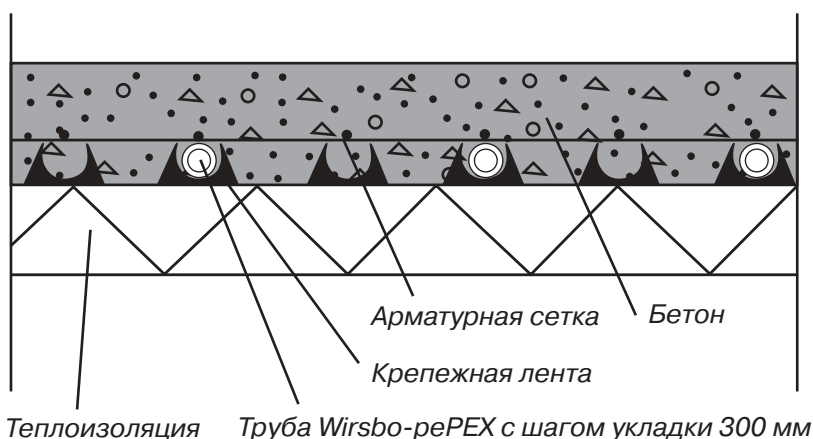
Бетонный пол на теплоизоляции из полистироловых плит. Петли трубы уложены на пластиковой крепежной ленте с зубцами или закреплены скобами.
